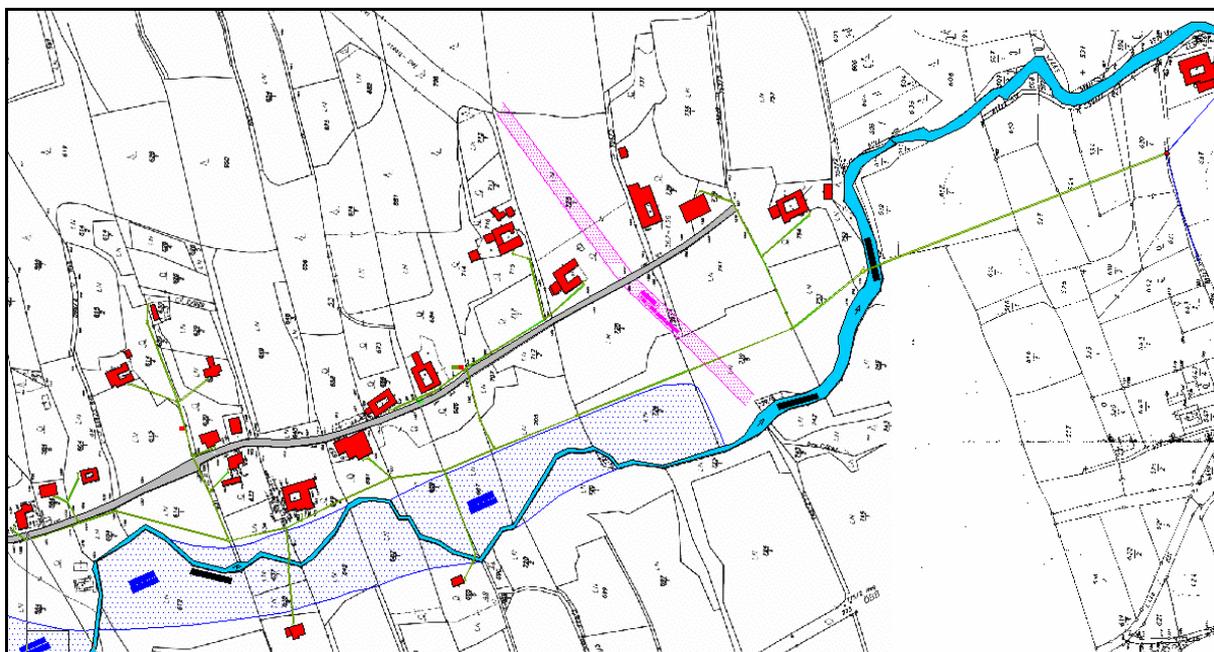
LAGEPLAN Variante 2 – Ableitung nach St. Johann
